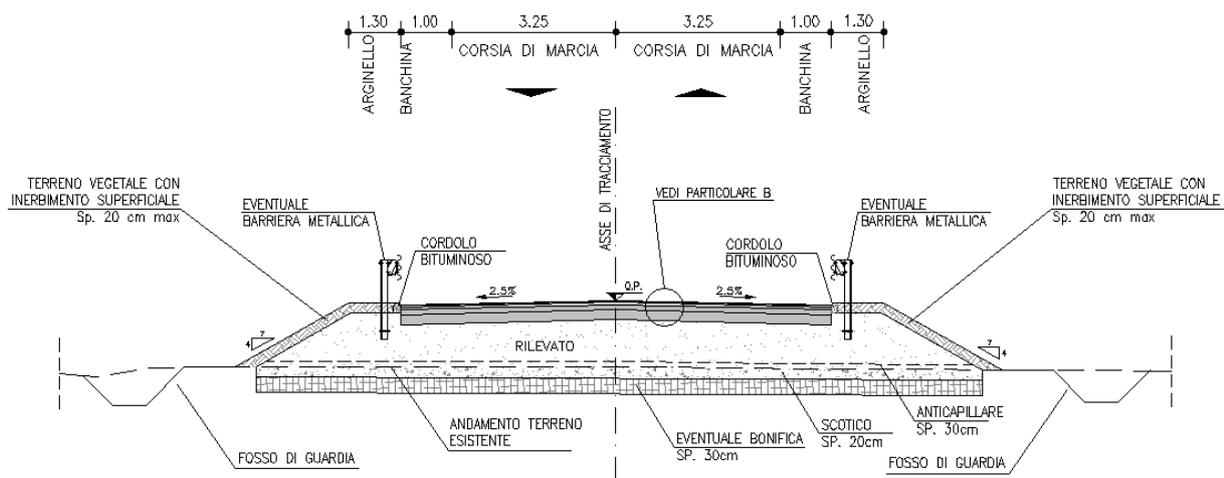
Sezione tipo di progetto strade locali via Serponti e via Bissone
